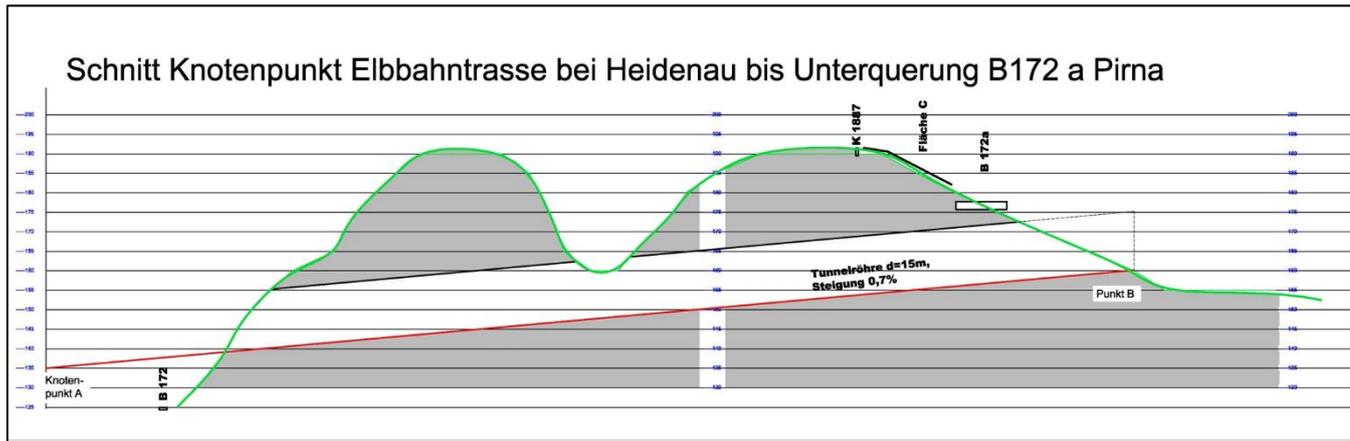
Vereinfachter Schnitt (zehnfach überhöht) der geplanten Neubaustrecke (Tunnelröhre mit 15 m Durchmesser angesetzt, Reliefkarte mit 5 m Höhenschritten)
